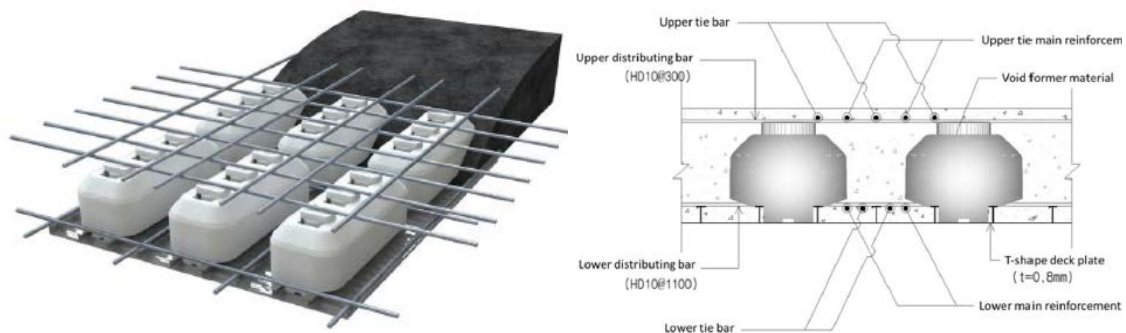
Modelado de disposición de los moldes con la armadura y sección transversal de la placa (PAIK, I., NA, S., 2018)
